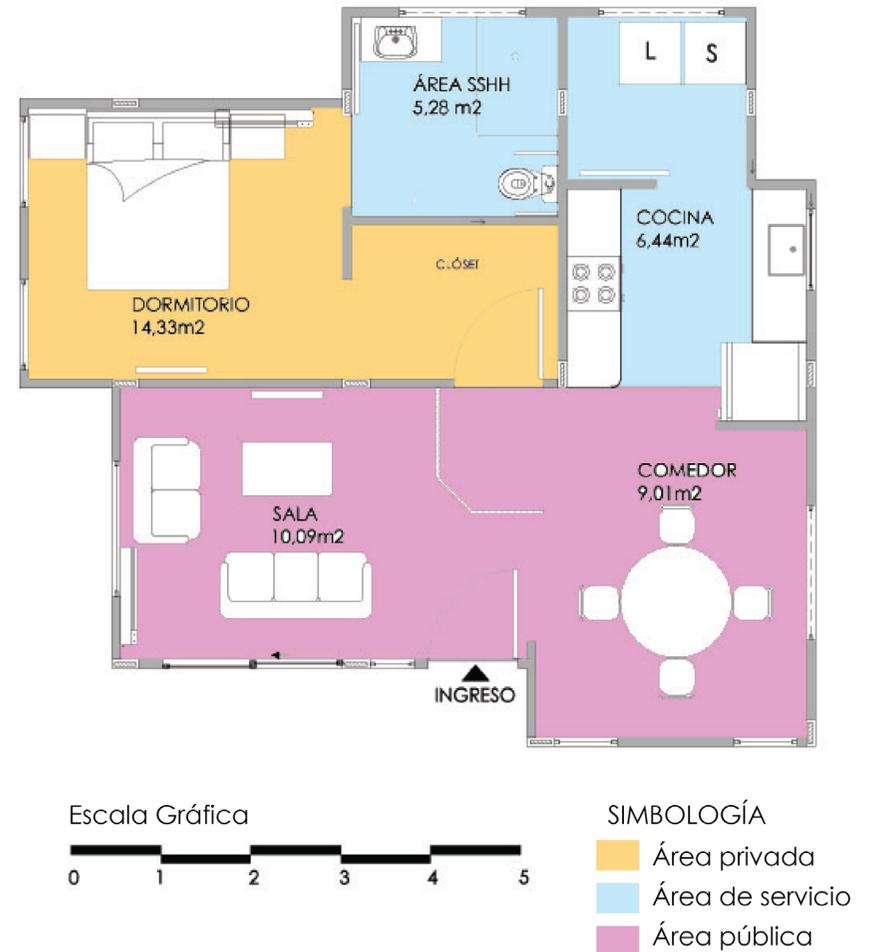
Planta arquitectónica tipo y zonificación de apartamento individual tipología II. Elaboración propia.
